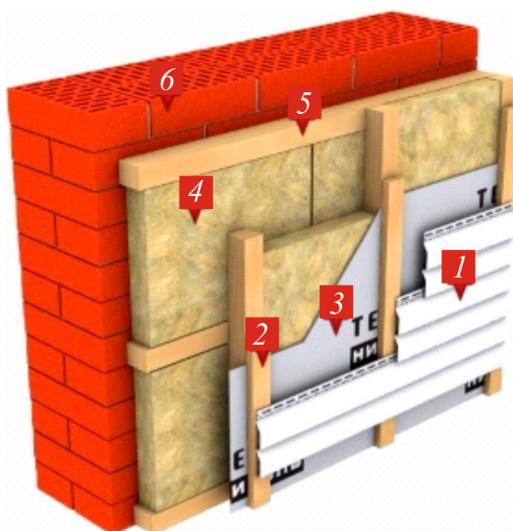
Пример конструкции навесного вентилируемого фасада:
